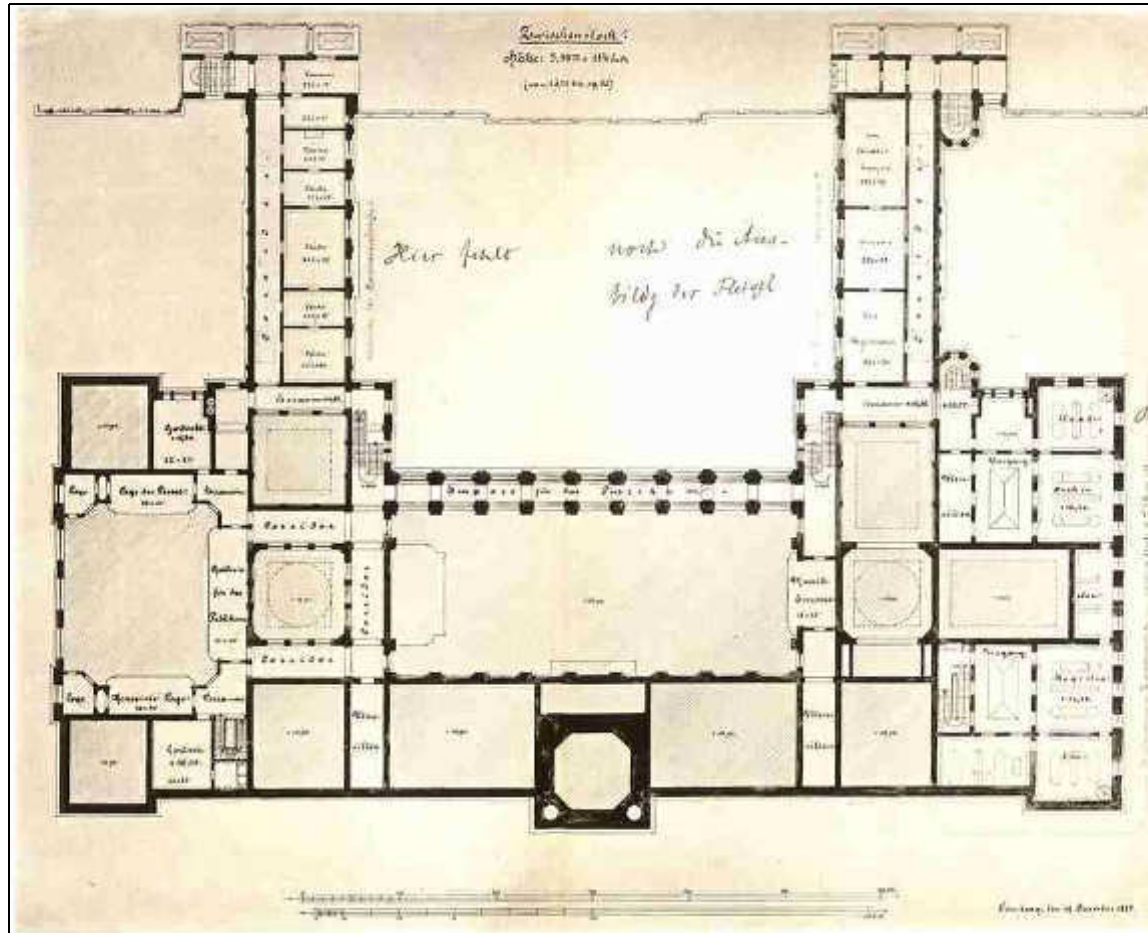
Rathausbau Grundriss Zwischengeschoss vom 19. Dezember 1885.
